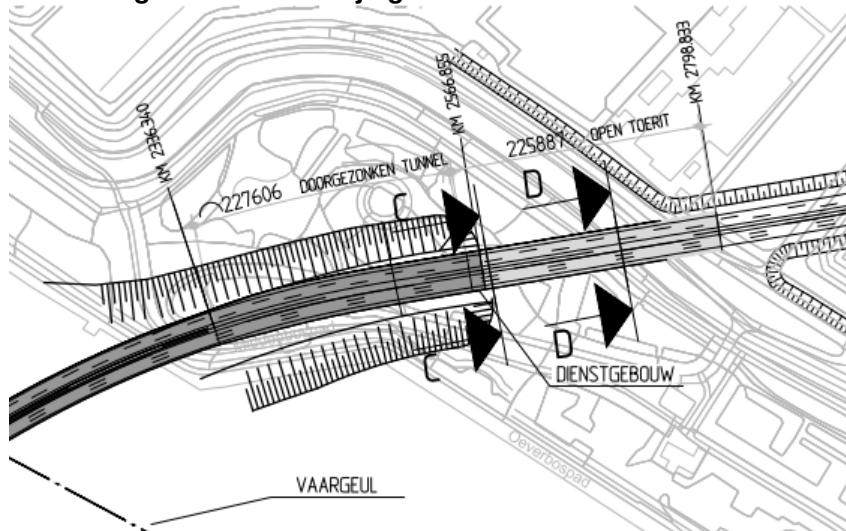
Noordelijke tunnelmond Blankenburgtunnel
